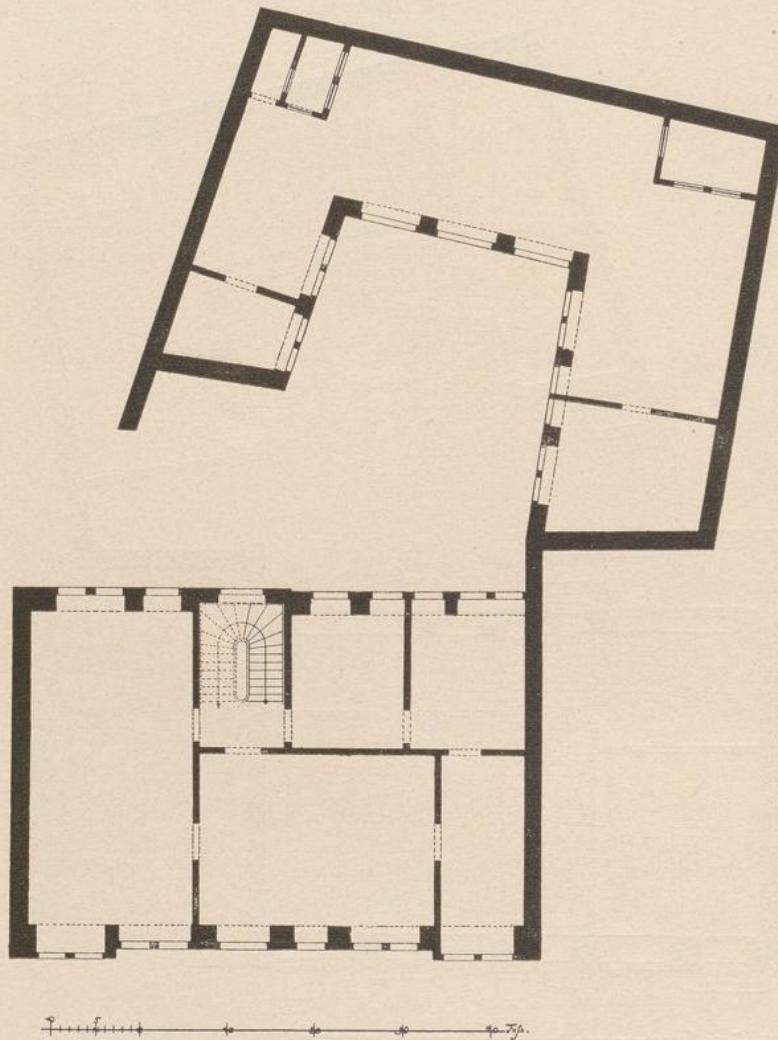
Engelthaler Hof; Grundriss des ersten Obergeschosses.
